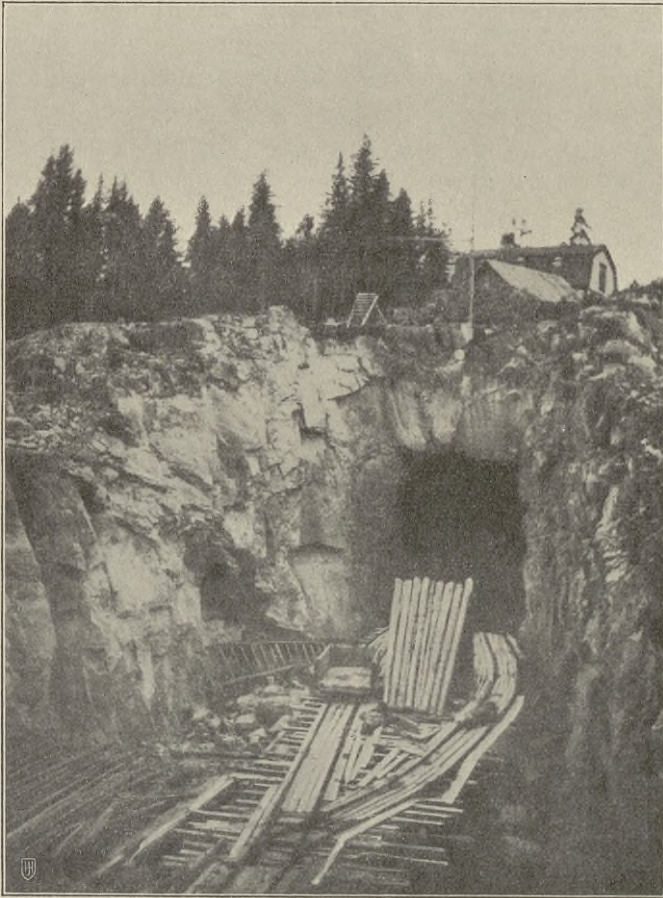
Svaelfos. Tunnelauslauf im Bau 1906.
